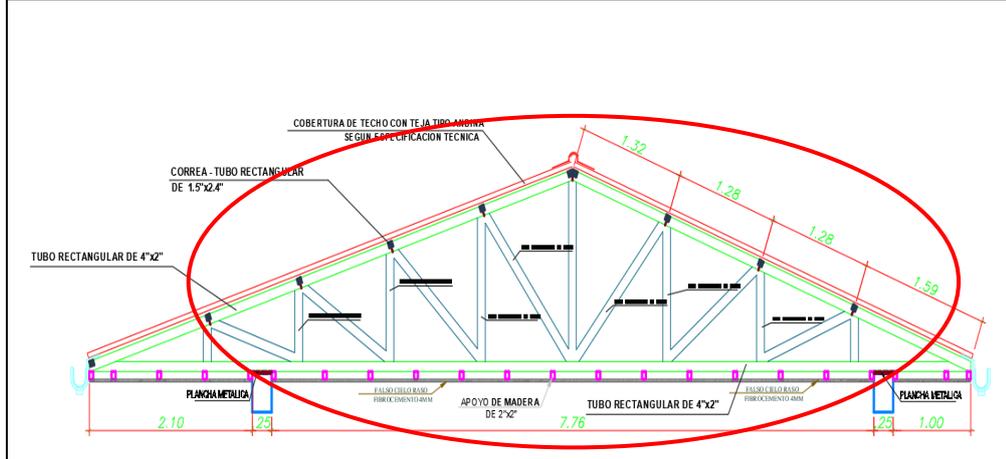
En los planos de techo el planteamiento indica la colocación de tijerales tipo cercha elaborado con perfiles de acero rectangulares.
